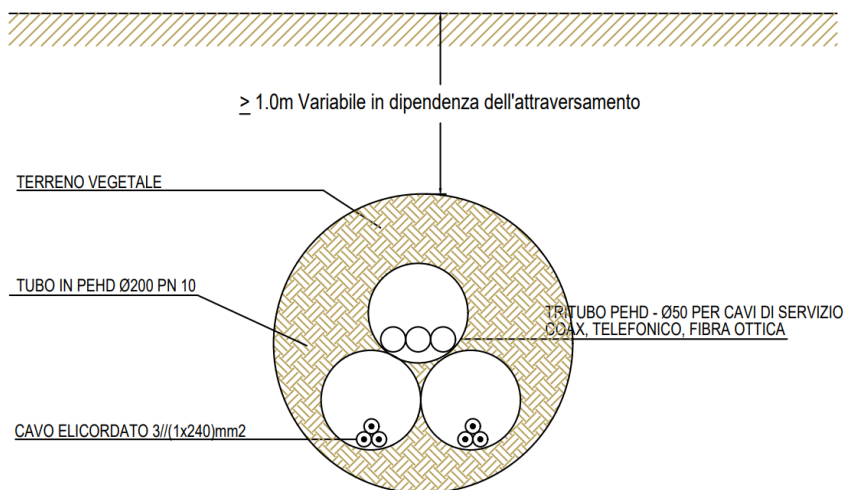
Sezione tipo T.O.C. – Attraversamento con sonda teleguidata
